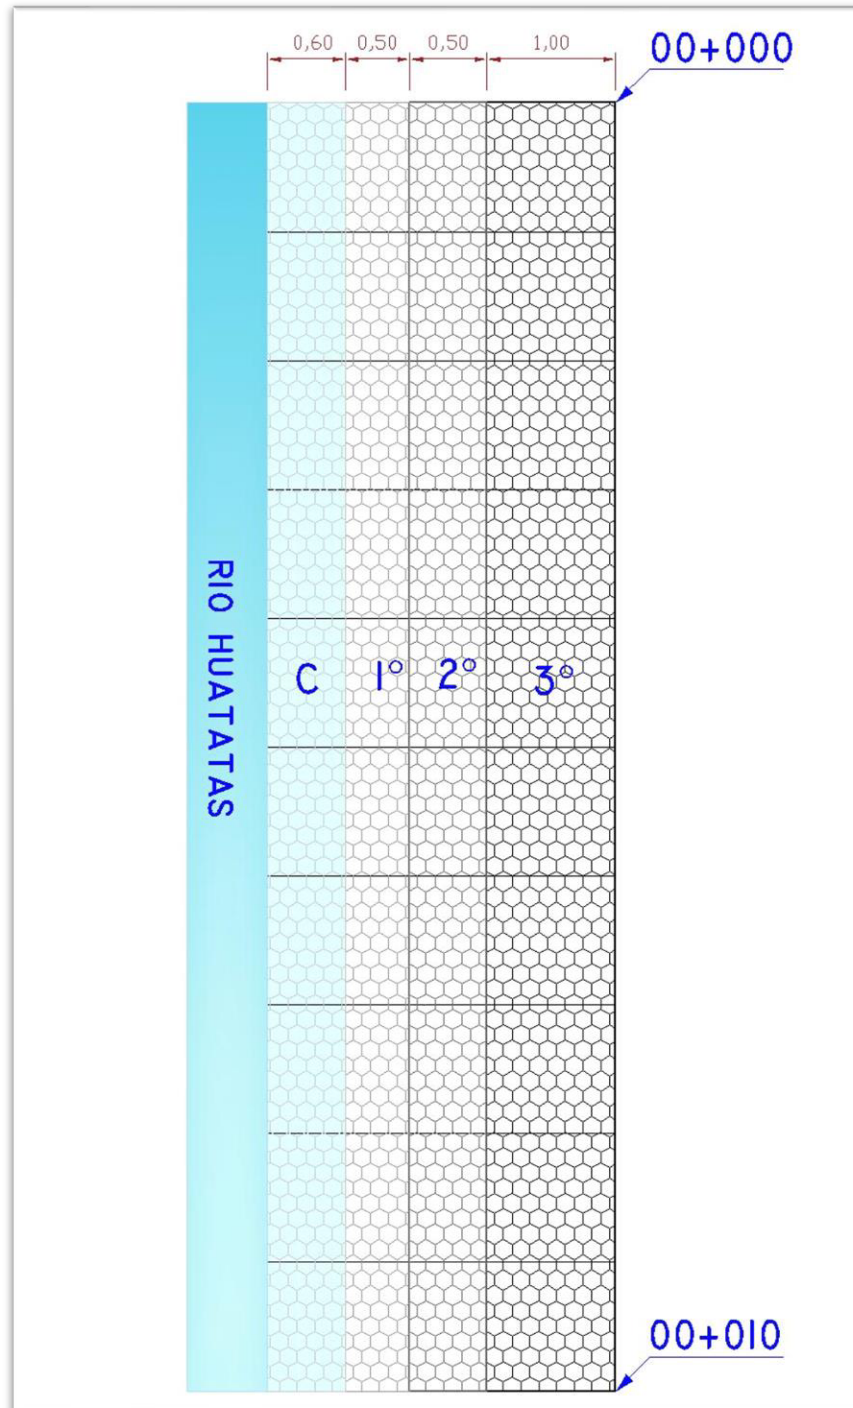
Vista en planta de la primera progresiva del muro de gaviones
